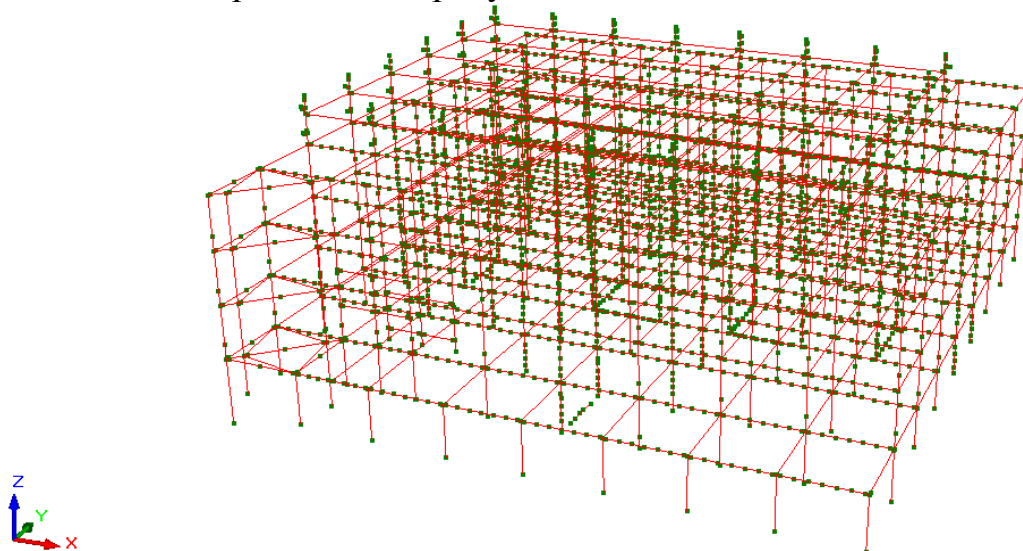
Расчетная схема (от уровня ростверков до уровня покрытия)
